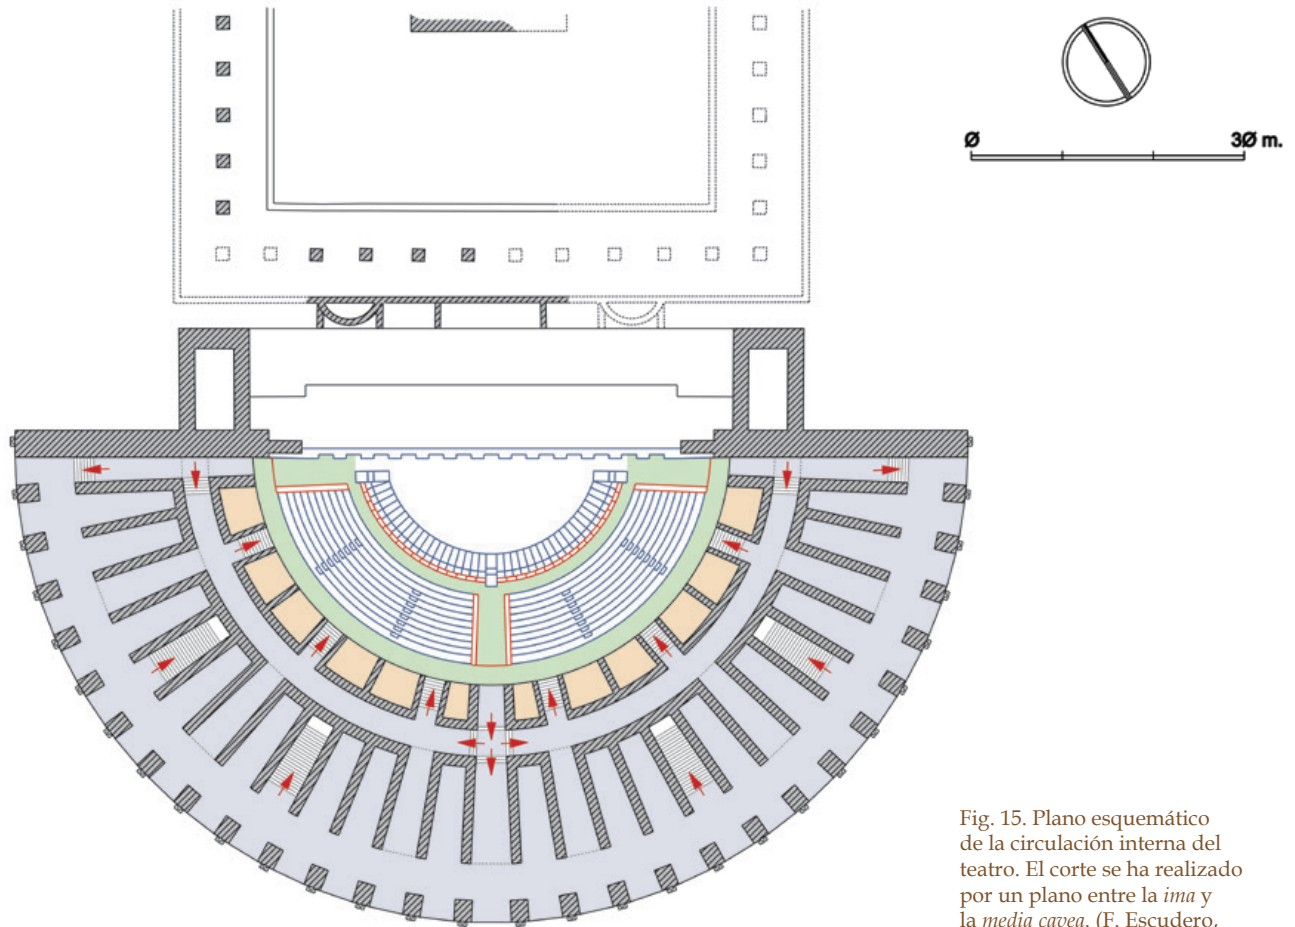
Plano esquemático de la circulación interna del teatro. El corte se ha realizado por un plano entre la *ima* y la *media cavea*. (F. Escudero, dibujo de A. Turón)
